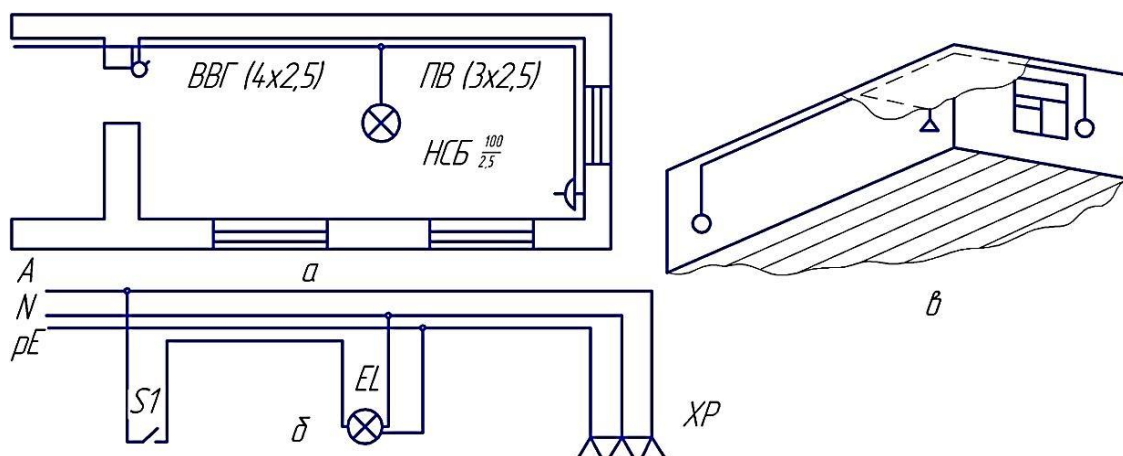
Монтаж электропроводки производственных помещений: а – план осветительной сети, б – электрическая схема, осветительной сети, в – эскиз комнаты с расположением осветительной электропроводки
